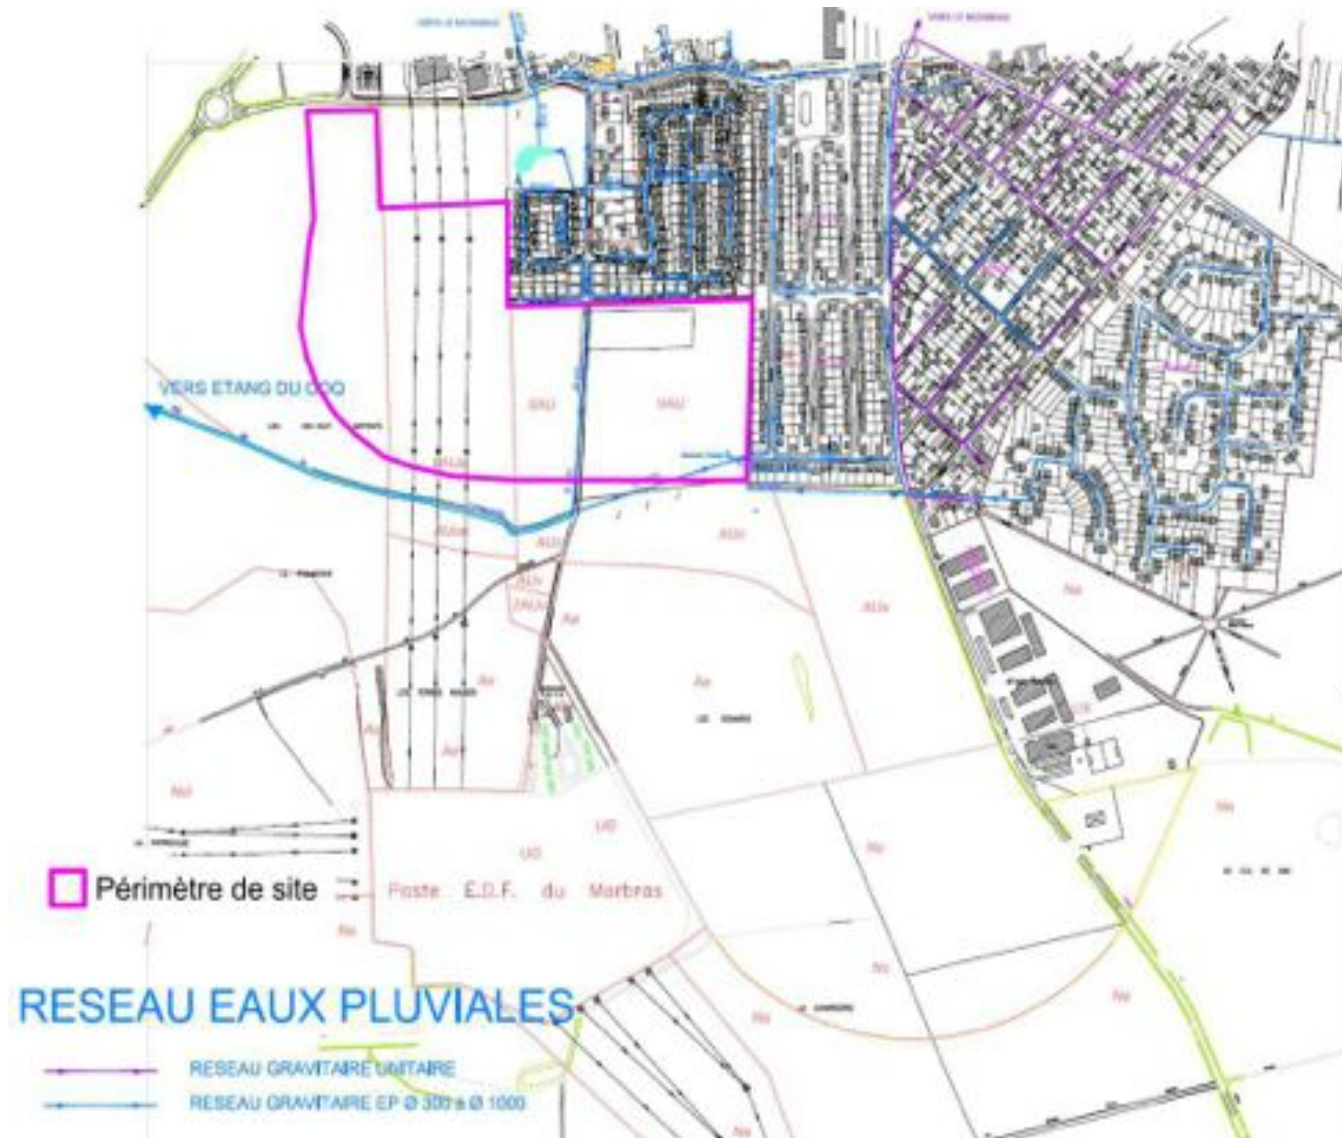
Plan des réseaux d'eaux pluviales à proximité du projet (source SETU, 2013)
